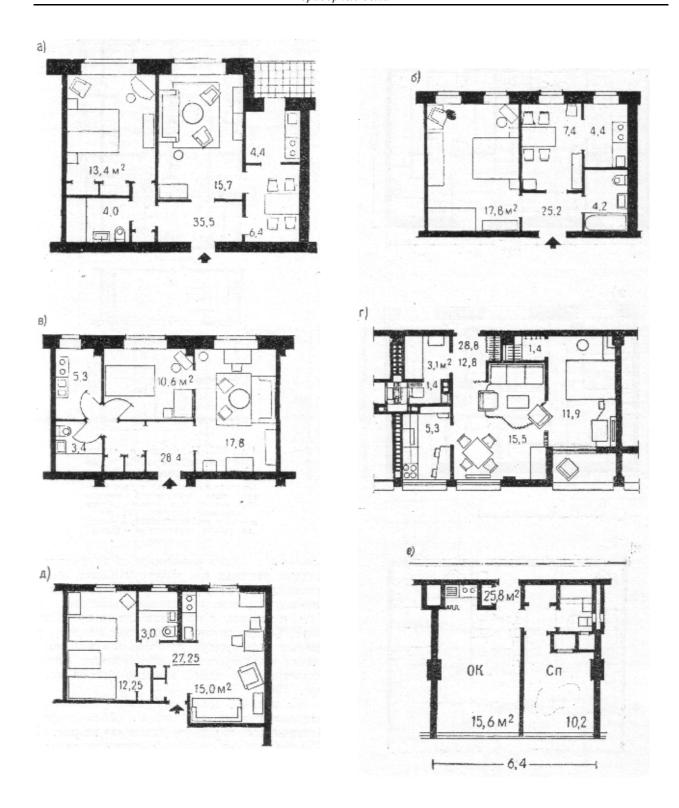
Двухкомнатные квартиры в коридорных домах a — раздельное размещение санузла и кухни (СССР); б — санузел и кухня-столовая размещены смежно вдоль одной из межквартирных стен (СССР); e — то же, спальня изолирована (СССР); e — то же, проходная общая комната (Франция); d — светлый санузел и кухня размещены в средней части квартиры (США); e — минимальные подсобные помещения, кухня-ниша в общей комнате (США);
